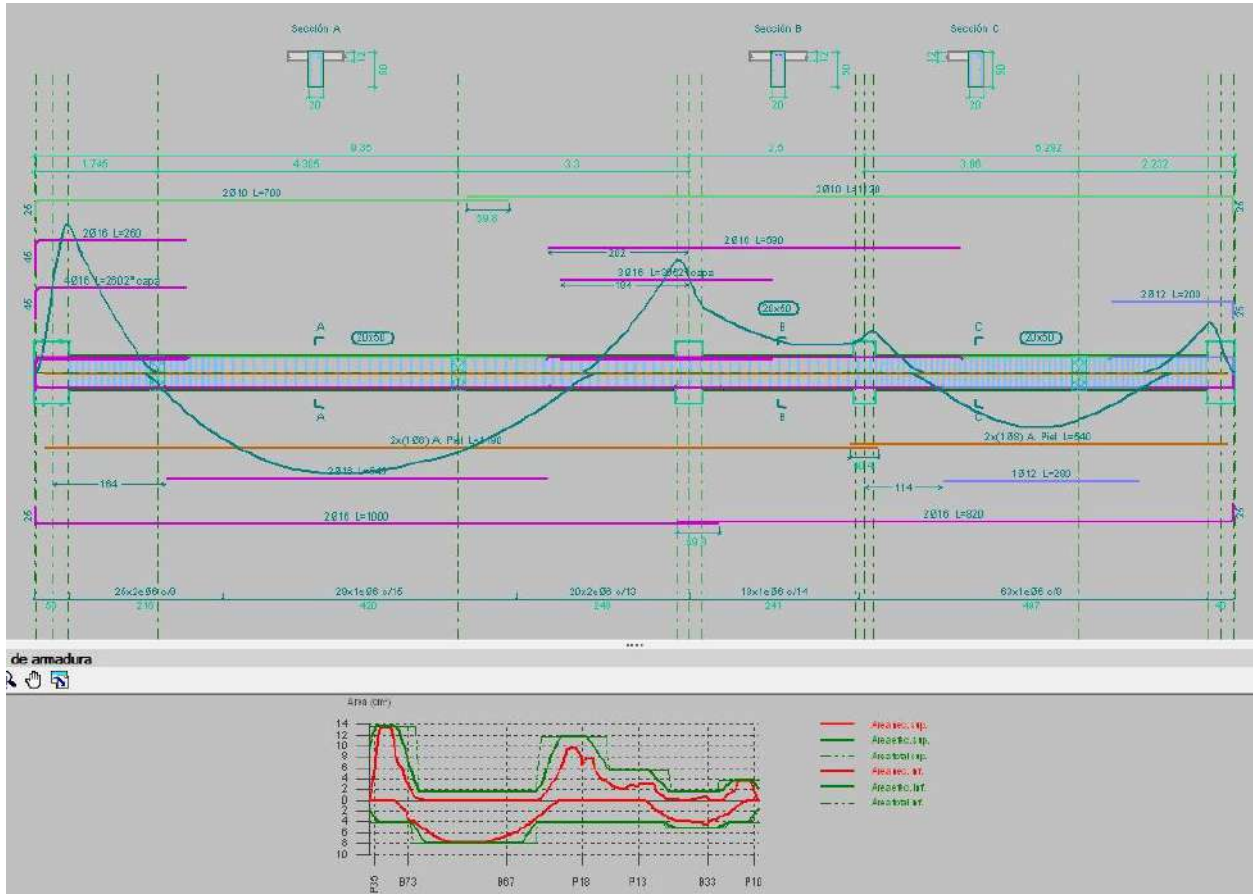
Área requerida/Área efectiva viga N° 10 Planta Primer Nivel Fuente: Imagen de Cypecad
